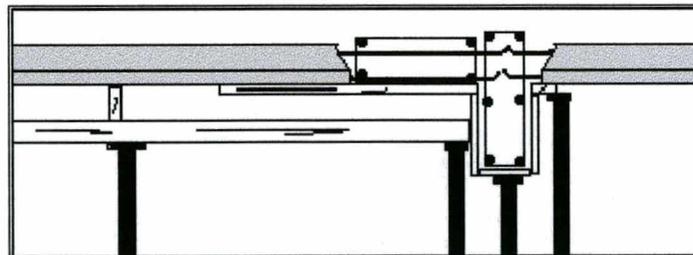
Detalhe de viga chata na laje com vigota pré-moldada.
